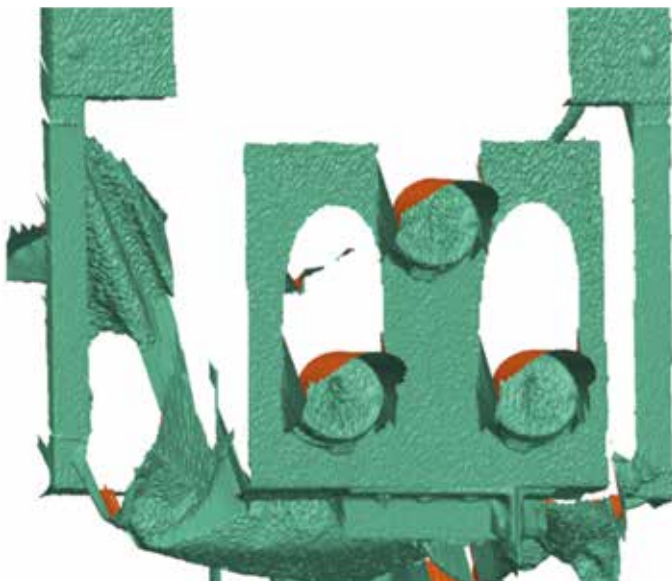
Ausschnitt einer Punktwolke mit feinen Details
